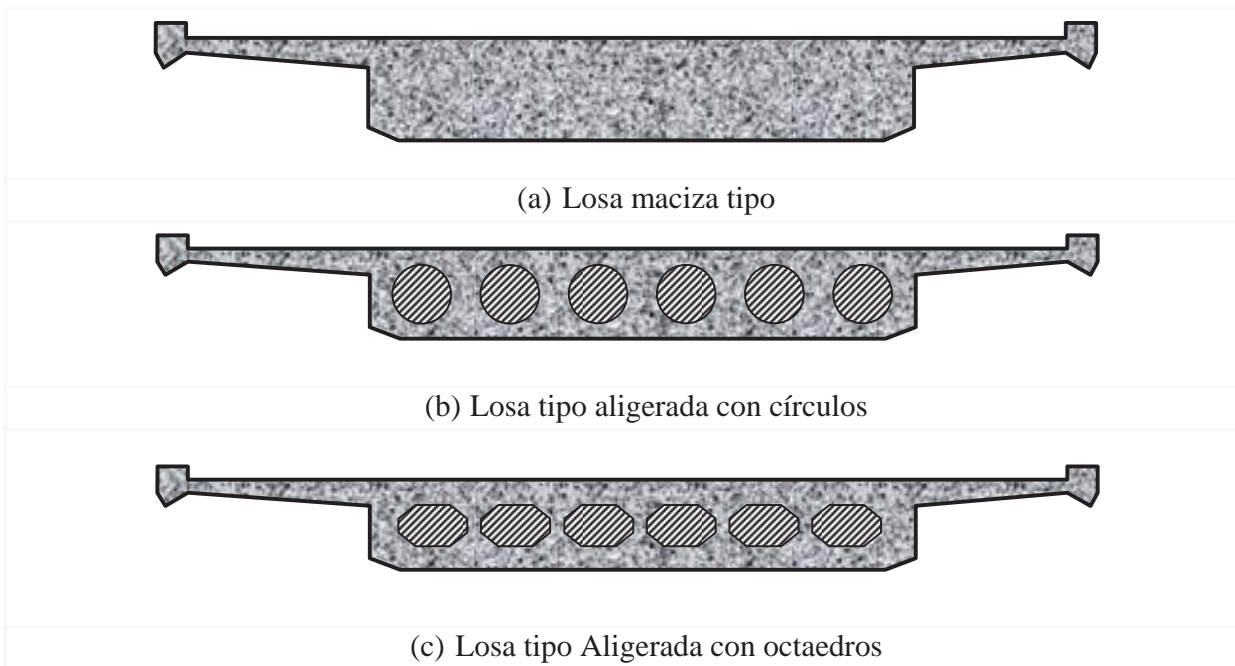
se esquematizan las secciones trasversal tipo de losas macizas y aligeradas
